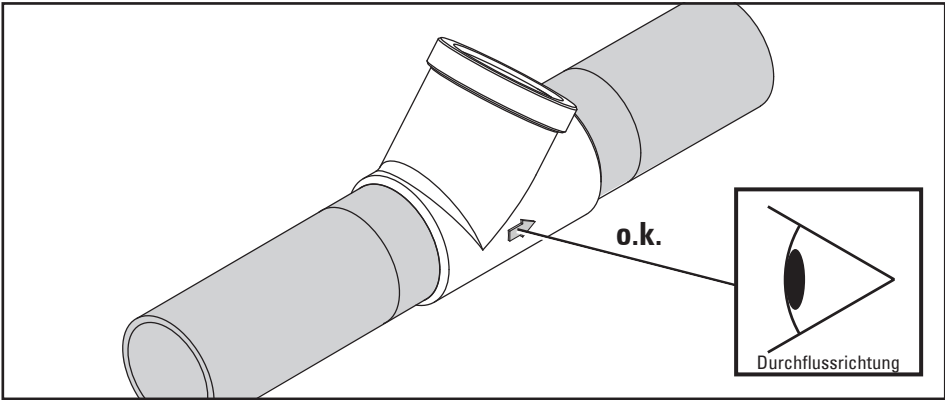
Anschweißen des Ventilgehäuses
